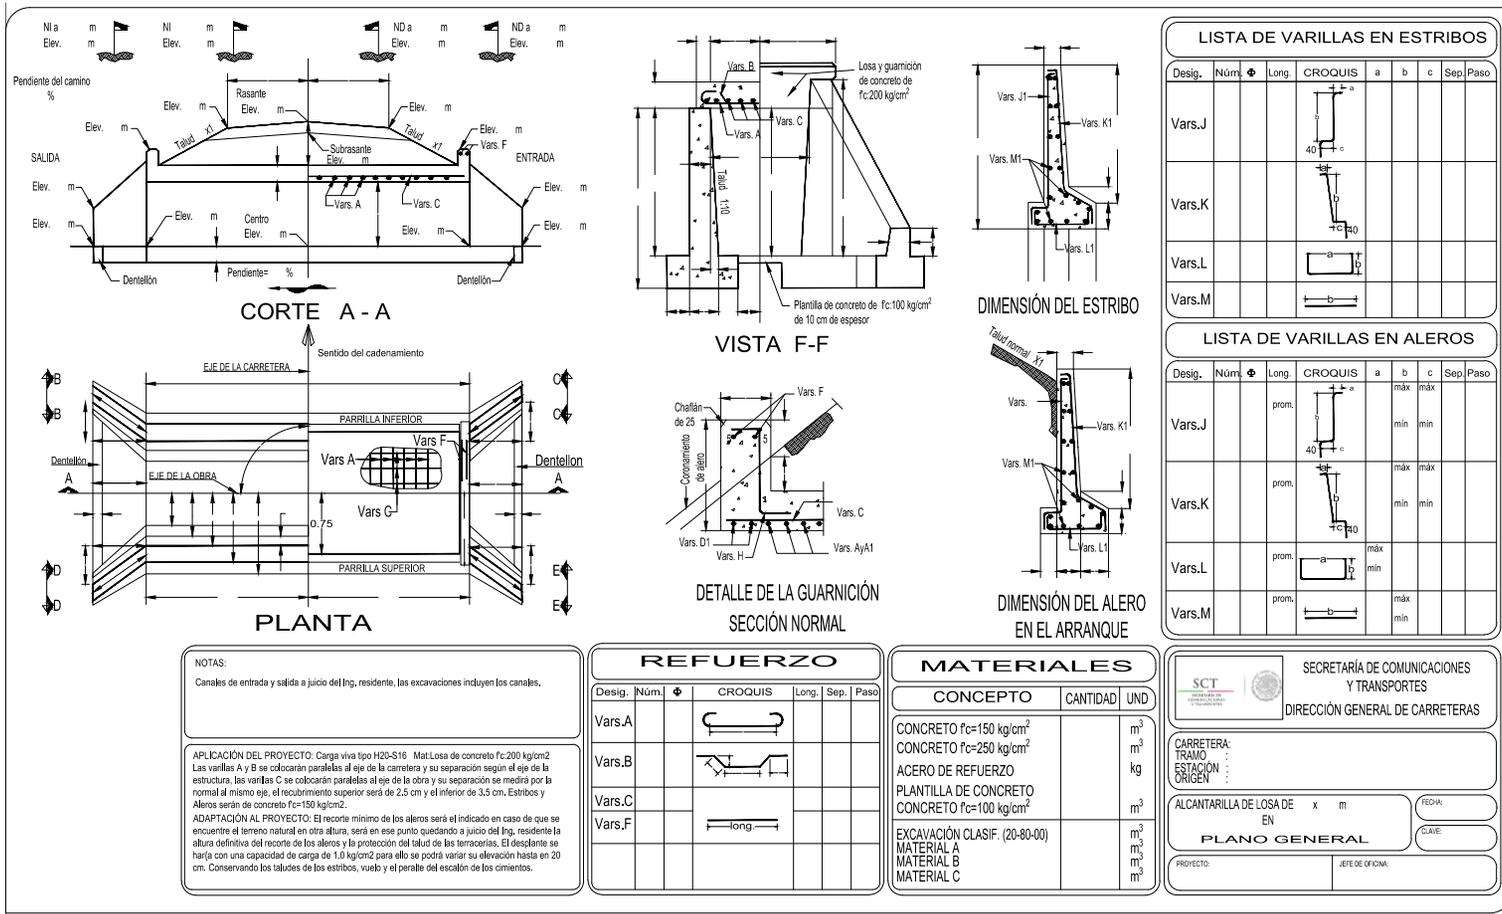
Planta y elevación de una alcantarilla de losa de concreto
